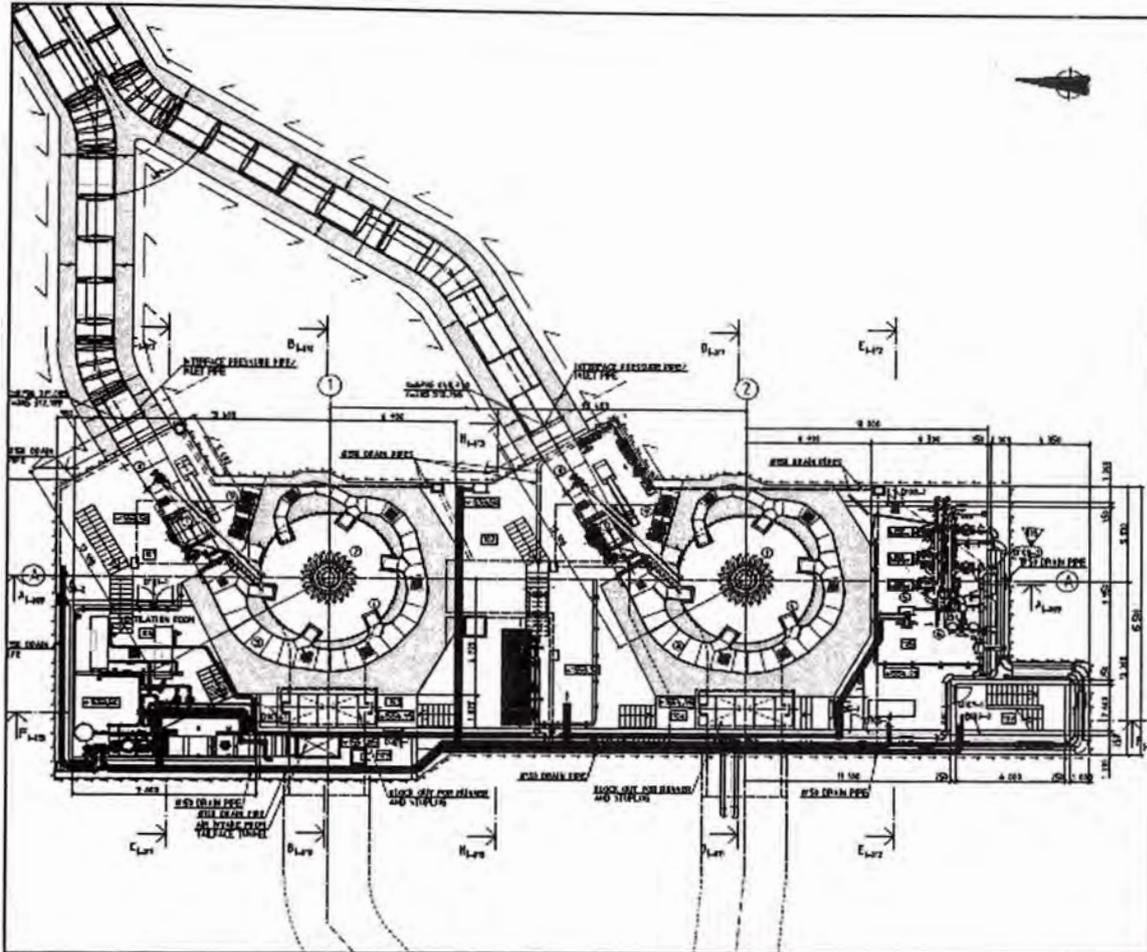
Plano en planta – Casa de máquinas C.H. Liple
